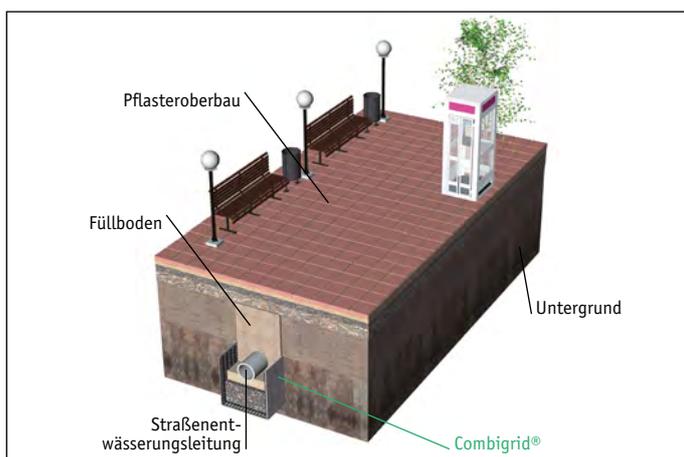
Rohrgrabenbewehrung (seitlich hochgezogen)
